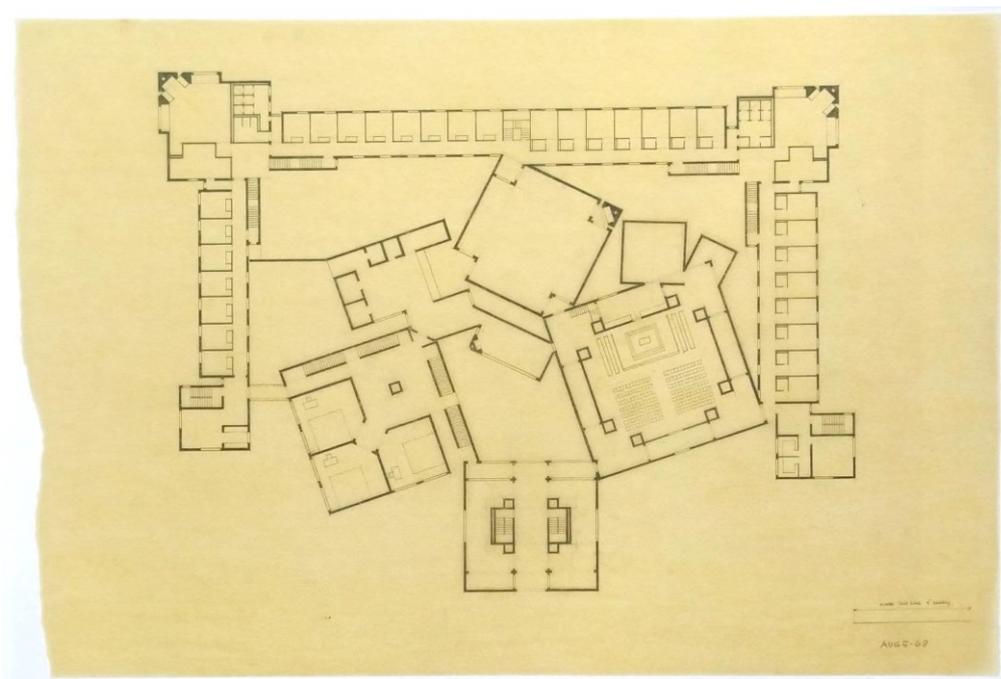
Casa-mãe Dominicana. Planta baixa do pavimento térreo da última versão do projeto. Louis Kahn, Agosto, 1968.
